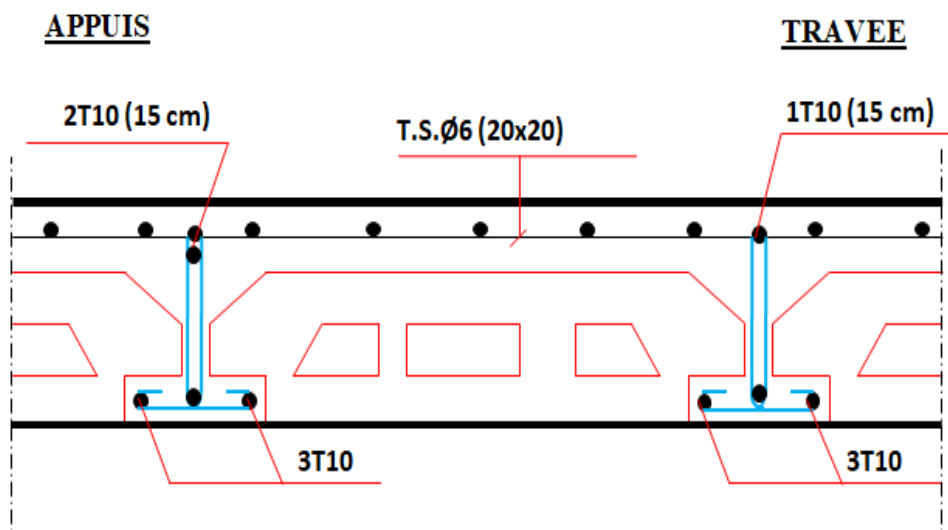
Schéma de Ferrailage de nervure (20+5).
